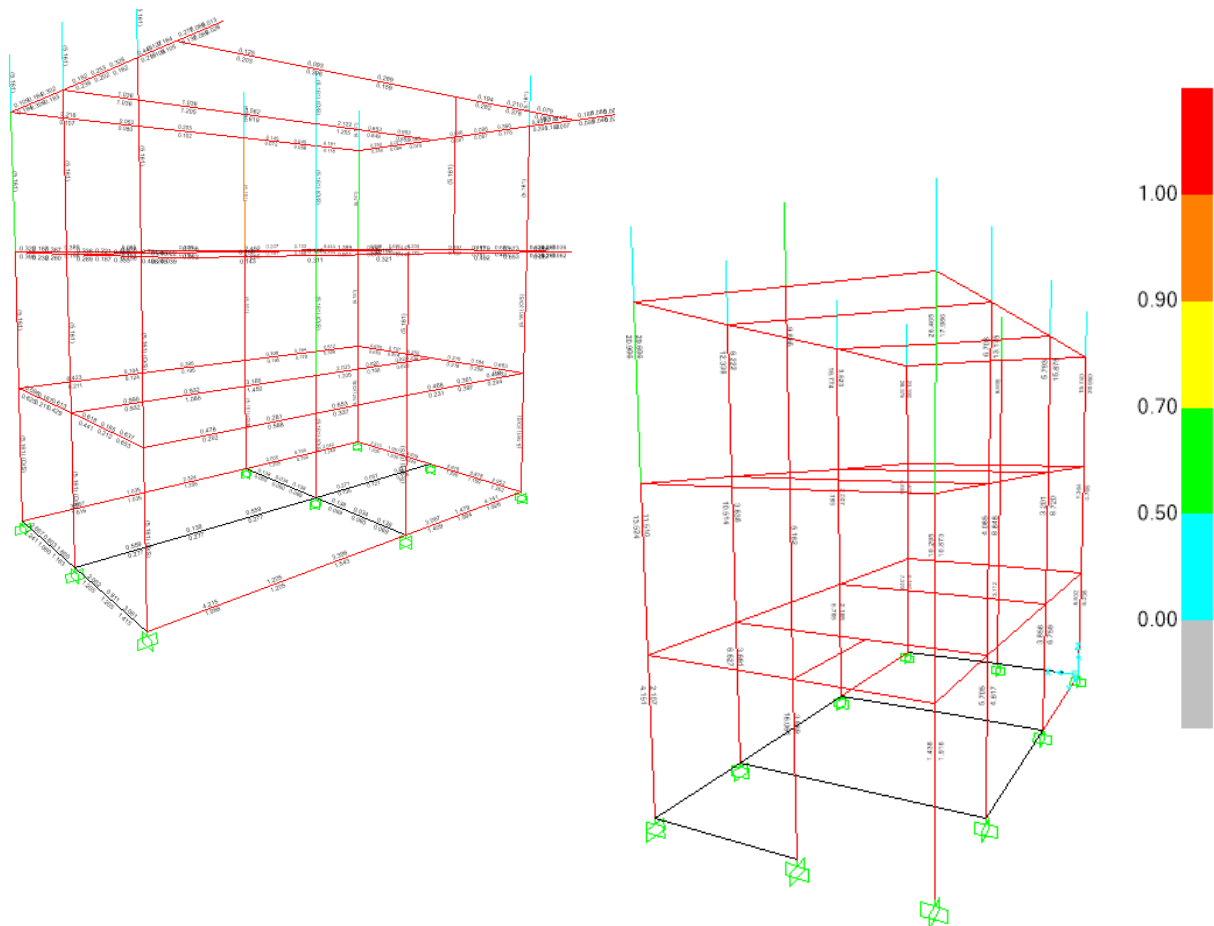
Valores de interacción en elementos como vigas o columnas para viviendas #1 y #2.
